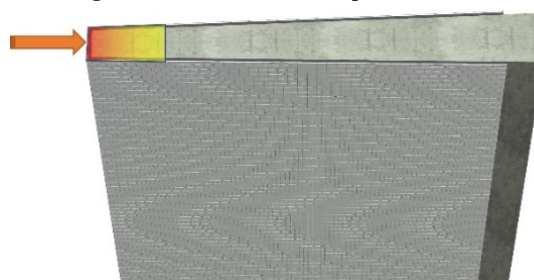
Pilar trapezoidal com junta “P8” - hospedeiro
